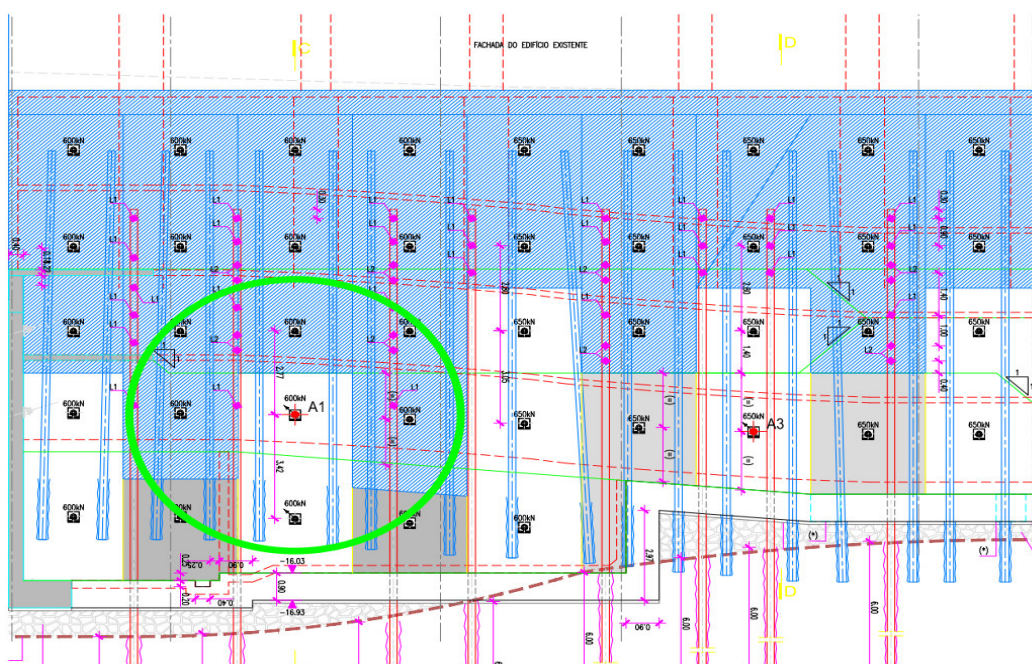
Alçado B, localização da célula de carga. [Fonte: Peças desenhadas, Projeto ECP]
